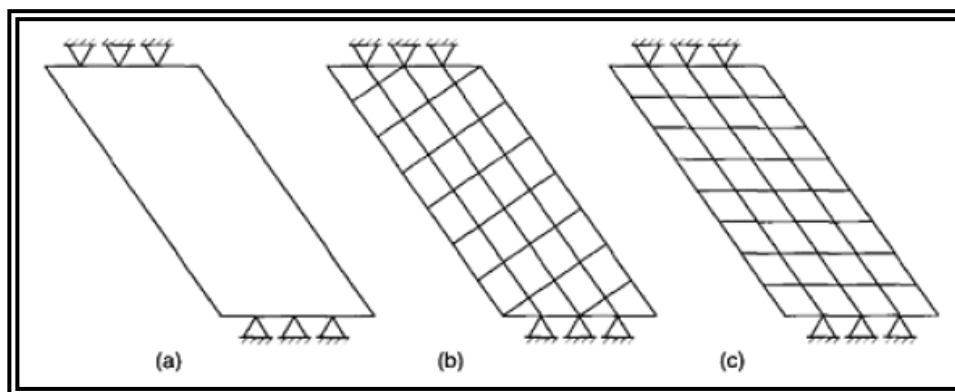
177 Tablero largo y estrecho: (a) Vista en planta, (b) Diseño de grilla, (c) Diseño de grilla alternativa¹⁹¹.
